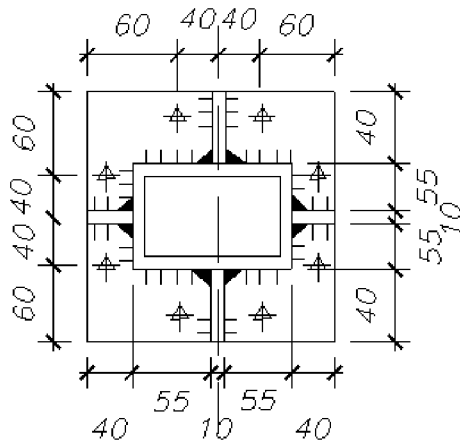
Схема монтажного вузла нижнього поясу
